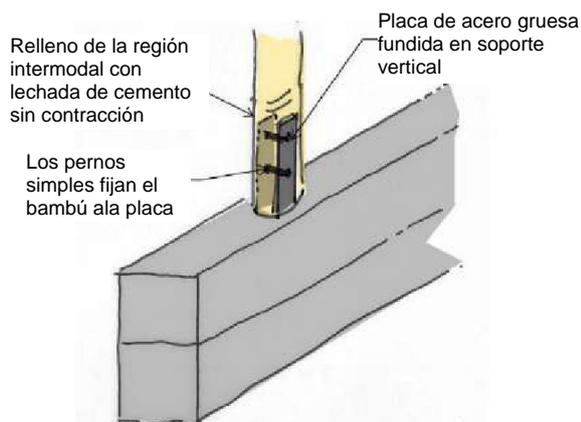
Placa de acero echada en el soporte vertical atornillado al bambú
